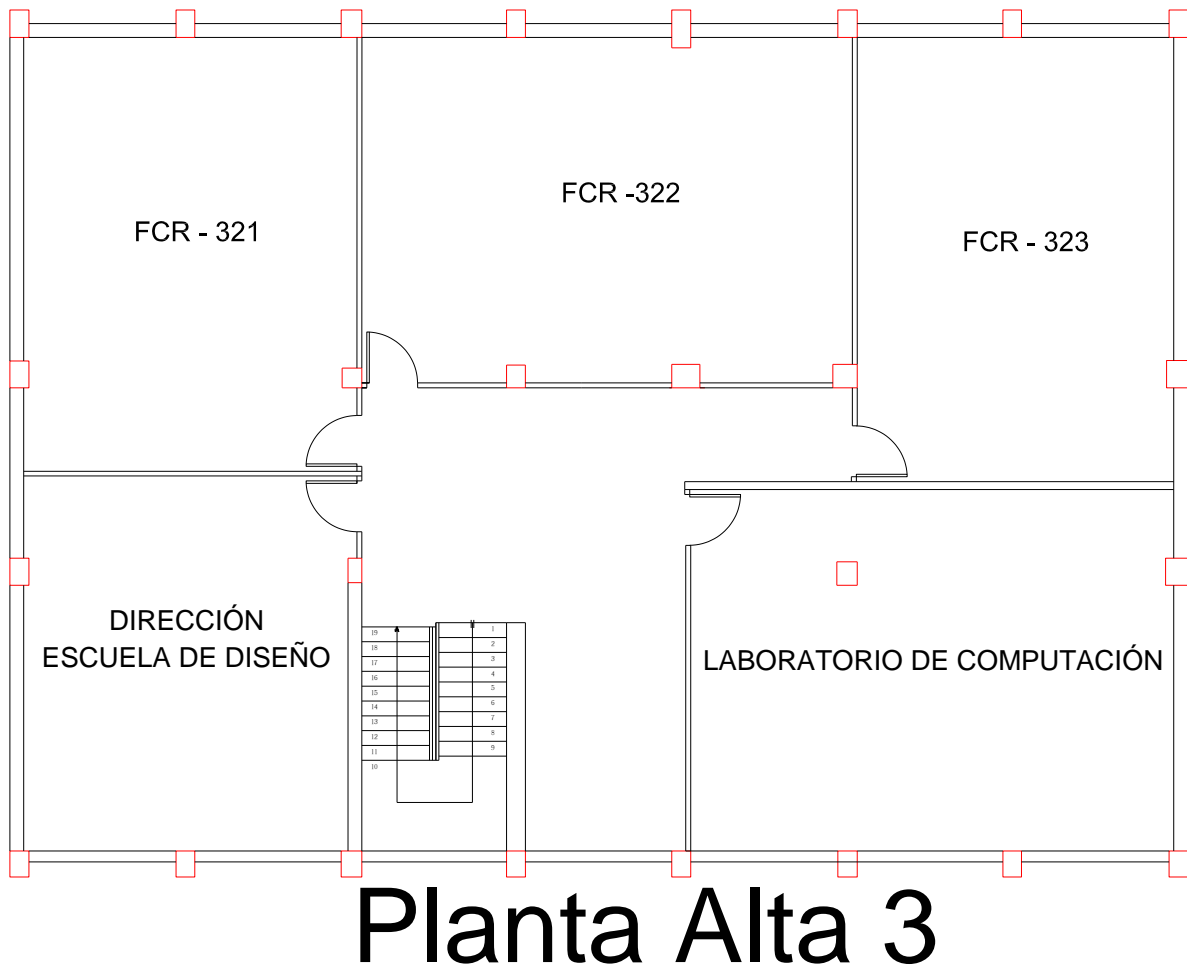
3ra. Planta Alta Edif. Dr. Francisco Campos Rivadeneira, Fuente: Cueva - Vera
